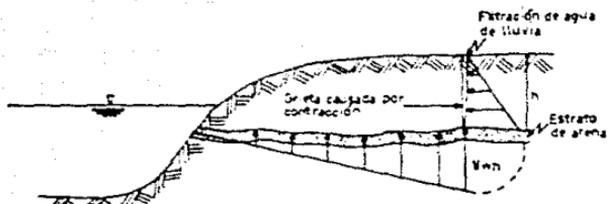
MECANISMO DE DESLIZAMIENTO DEL MATERIAL QUE FORMA UNA MARGEN (Ref. 7)
